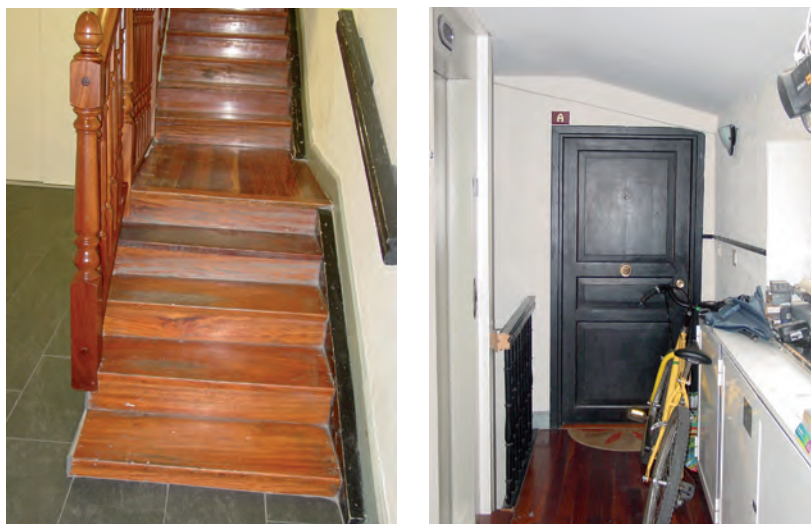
41. FOTOGRAFÍA DE PLANTA BAJA Y PLANTA BAJOCUBIERTA. ACCESO AL ASCENSOR. AÑO 2014
